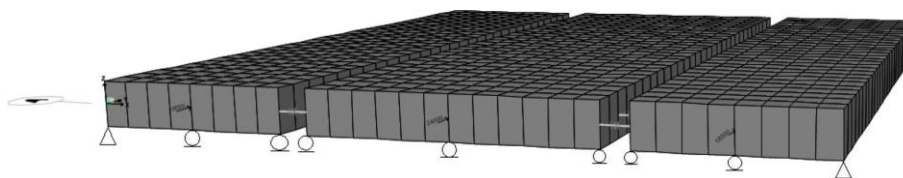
Modelo de losa CLT con conexión entre paneles.
